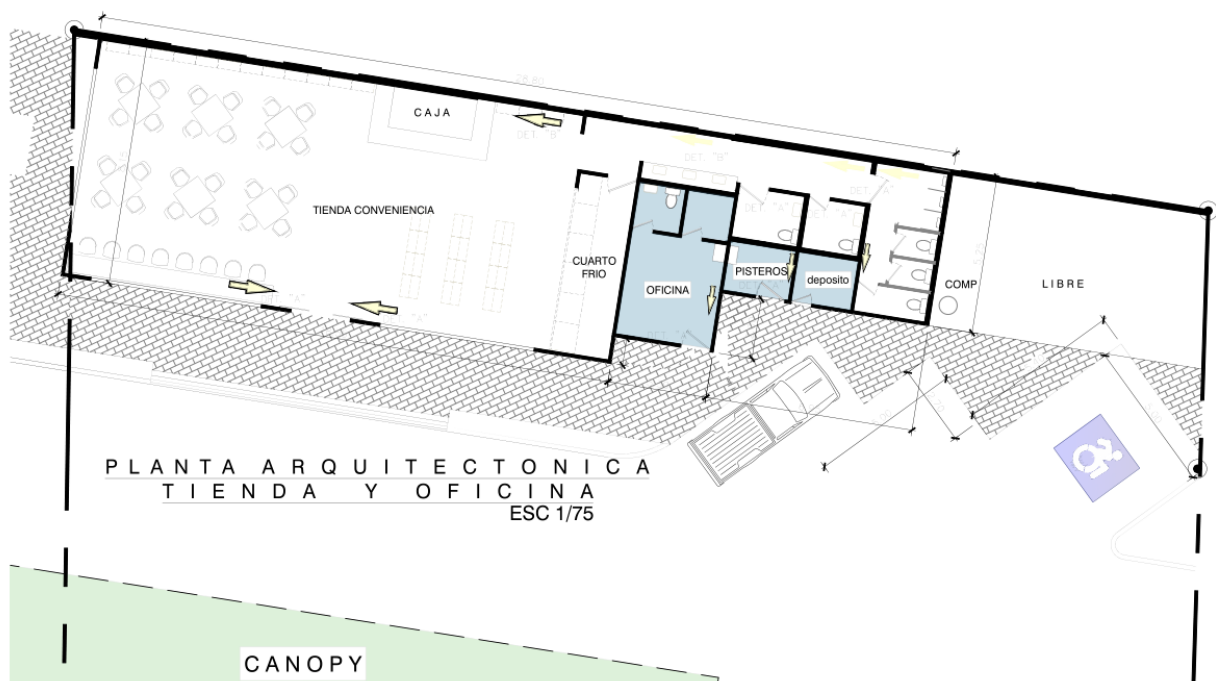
PLANTA ARQUITECTÓNICA DE TIENDA Y OFICINA
